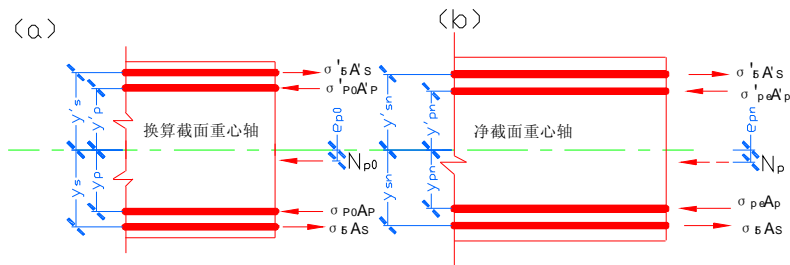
预应力钢筋及非预应力钢筋合力位置
